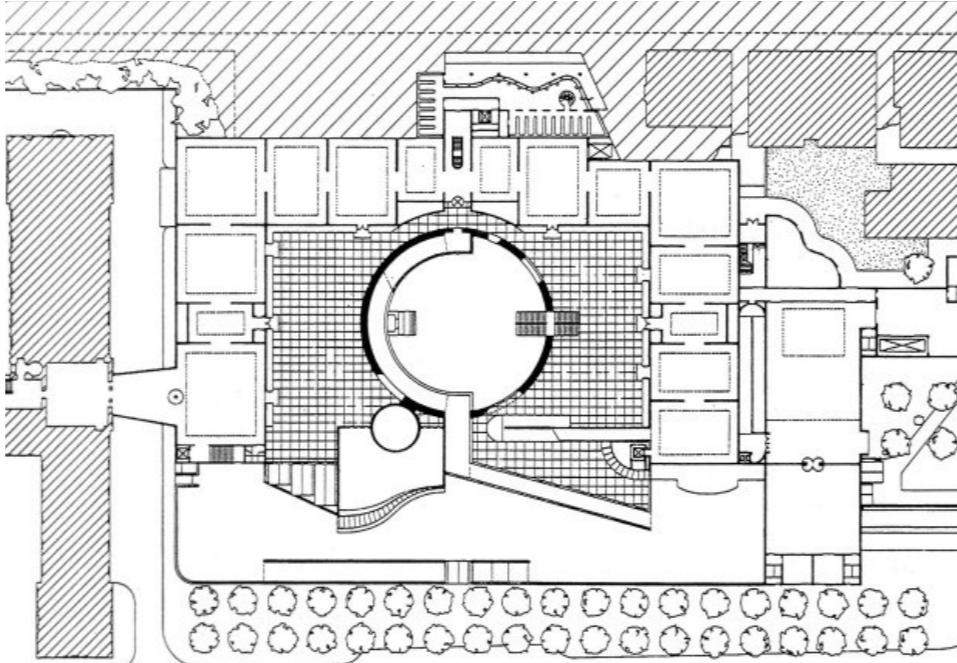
James Stirling, Neue Staatsgalerie Stuttgart, 1979-84, Grundriss OG
